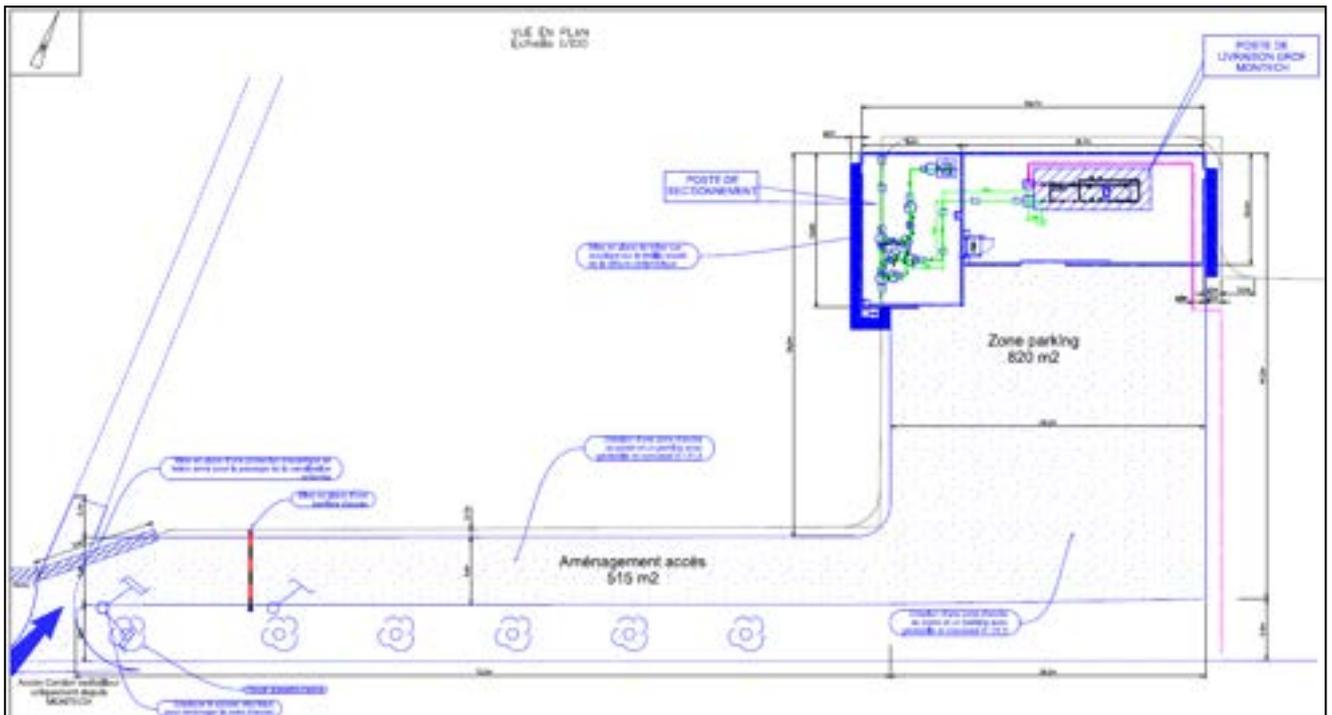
Poste de Sectionnement et de Livraison GRDF Montech projetés
